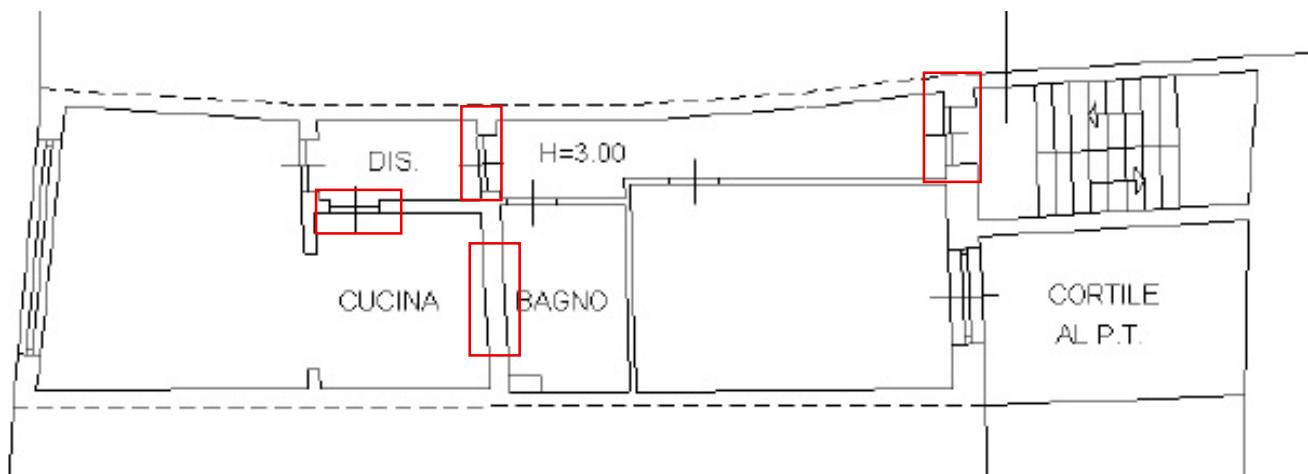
Estratto planimetria catastale dell'appartamento con indicazione delle difformità rilevate
